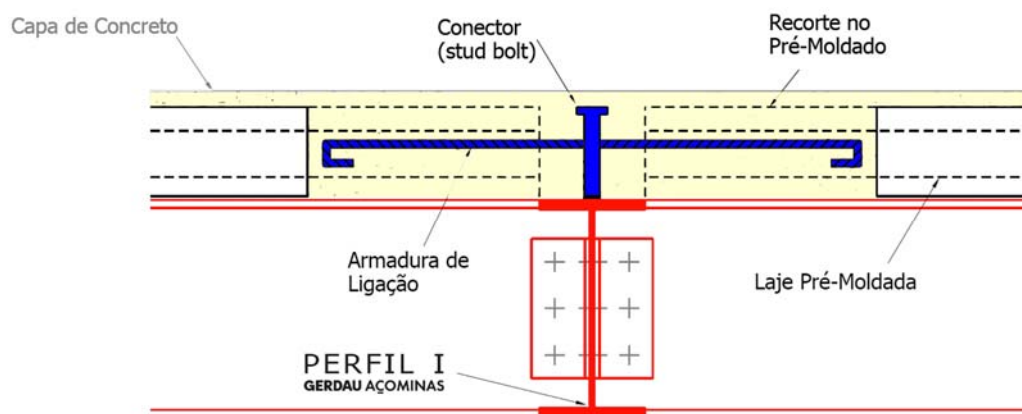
Detalhe construtivo de lajes alveolares apoiadas na viga metálica (Fonte: www.Gerdau.com.br)
